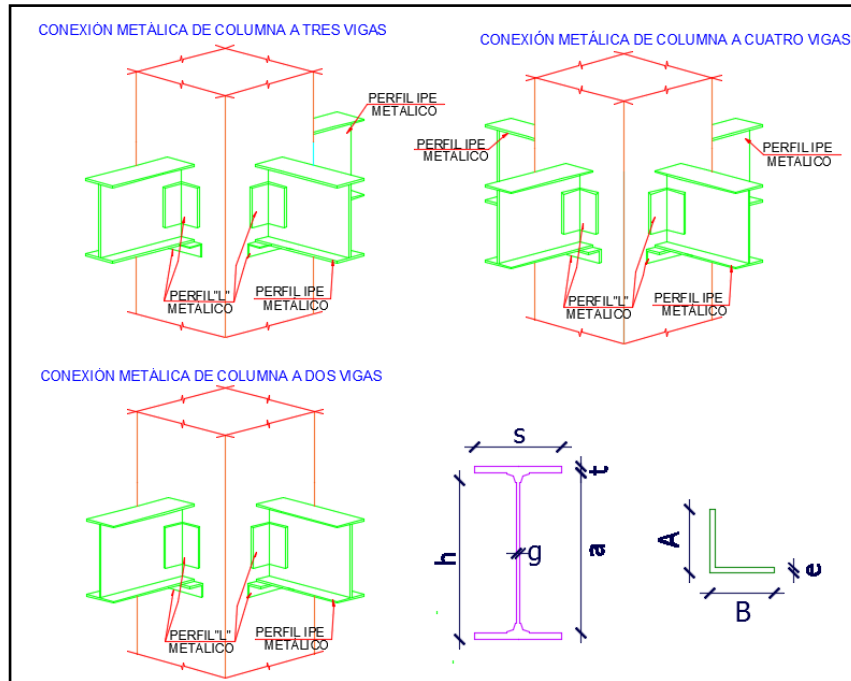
Conexión metálica columna-viga [Carreño J., Cañarte J., 2019]
